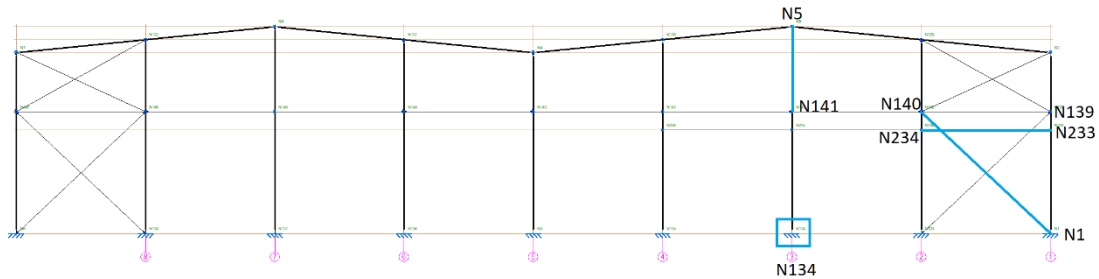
Nodos y vigas elegidos del pórtico de fachada.
